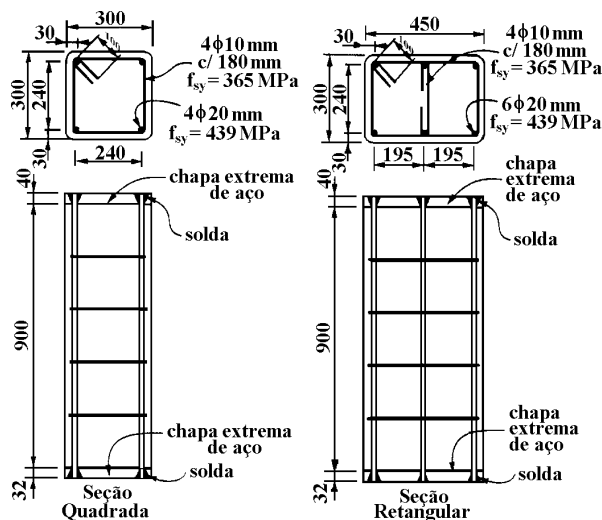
Pilares de Concreto Armado Ensaçados por WANG e RESTREPO (2001)
